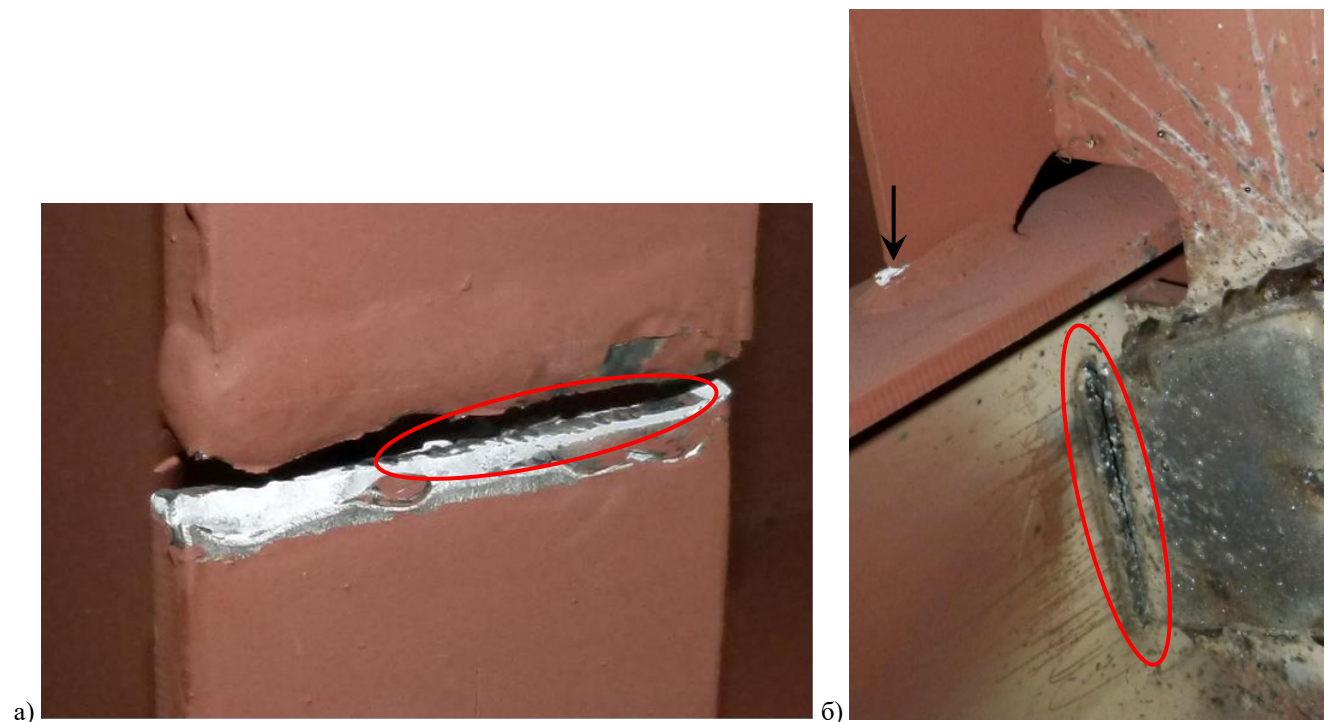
Типовые разрушения: а) разрыв сварного шва на пояске (виде непровар); б) отрыв книц опорного контура от поясков коротких балок и срез сварных швов
